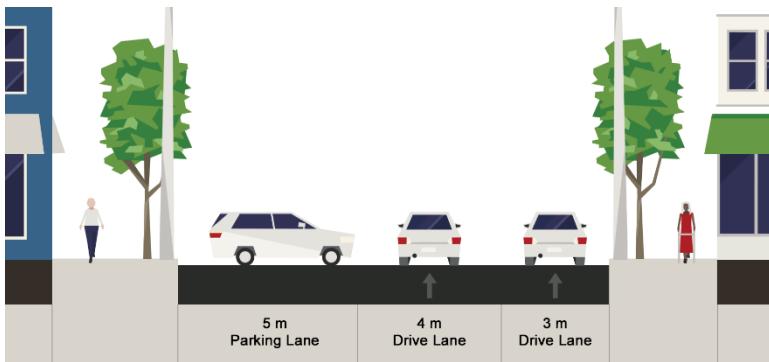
Fasilitas Penandaan *On-Street Parking* Jalan Praban
